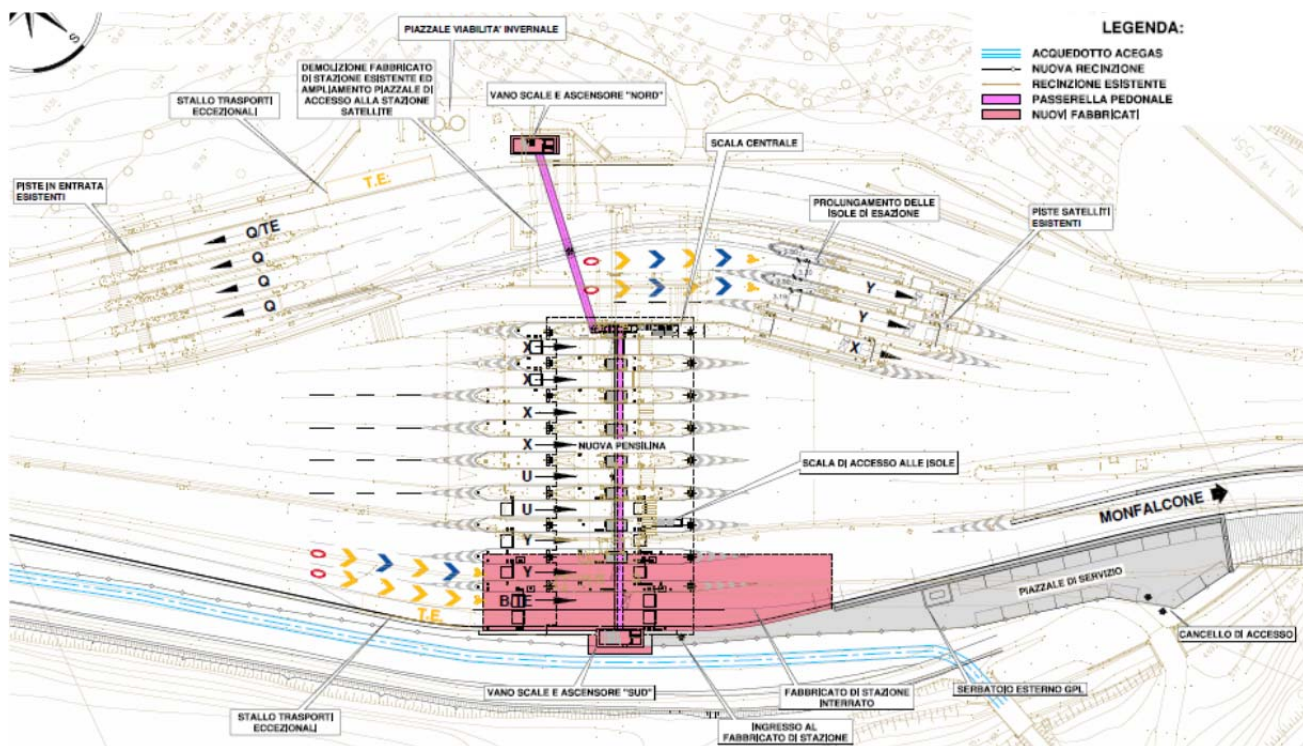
Pianta d'insieme (dalla tavola I.00.01.0.0).
